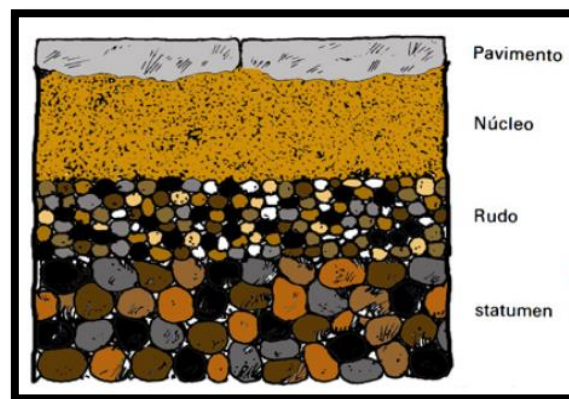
Estructura del pavimento en la antigüedad. (Lafarga, 2009).
